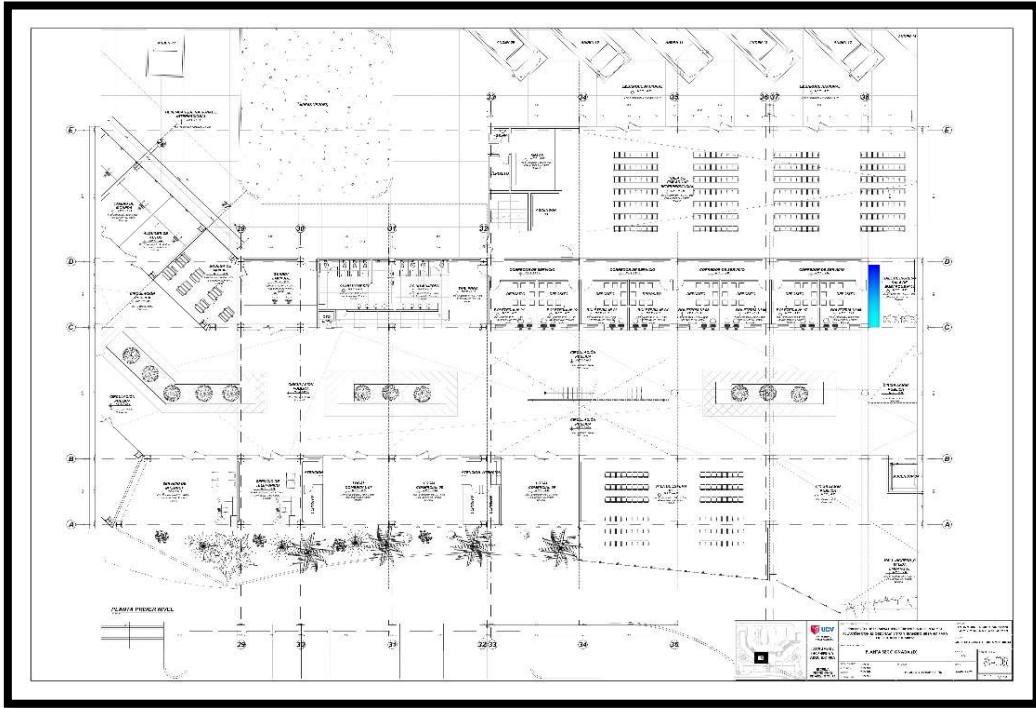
Plano Planta sector (D) Primer Nivel Fuente: Elaboración Propia.
